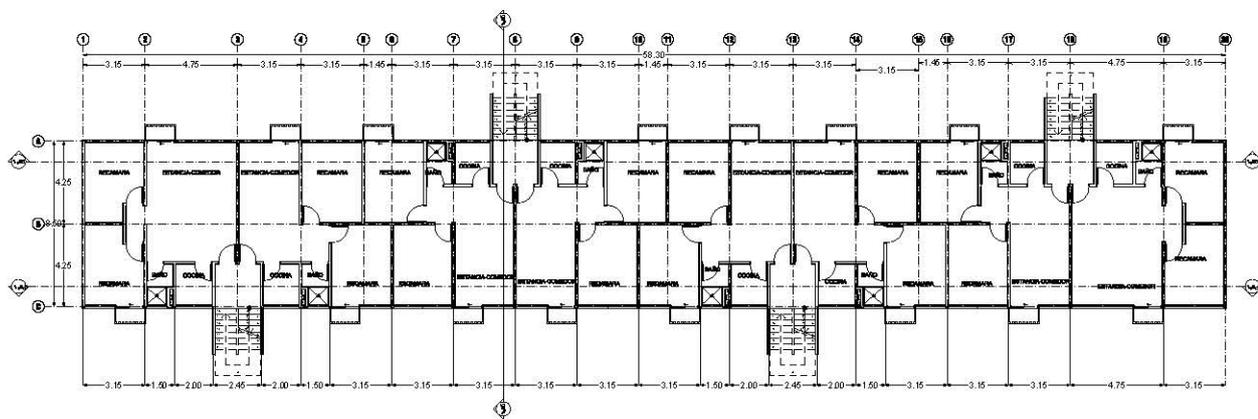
Planta de los edificios 2-A, 2-B y 2-C
